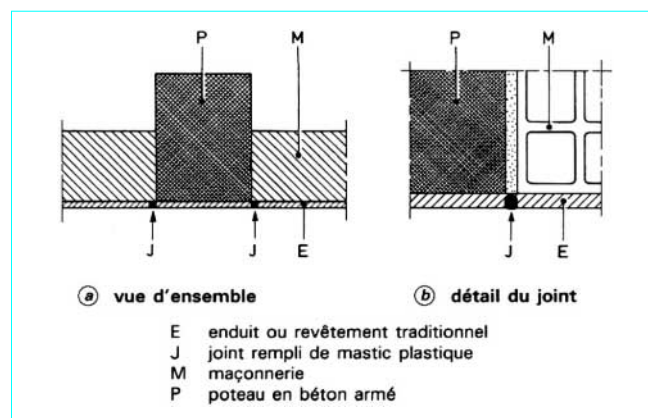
Poteau en béton armé et remplissage au même nu, avec joint dans l'enduit, rempli de mastic plastique
